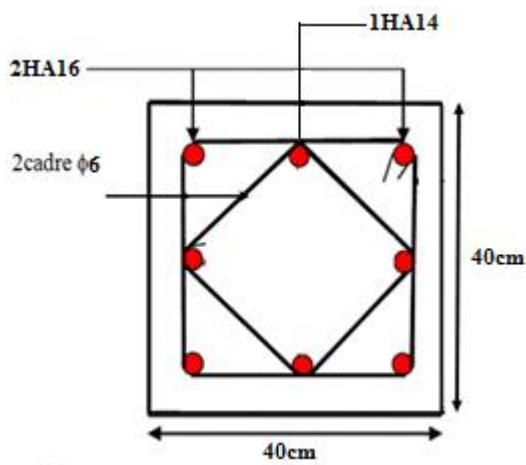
Schéma de ferrailage des poteaux 5^{ème} et 6^{ème} étage.
